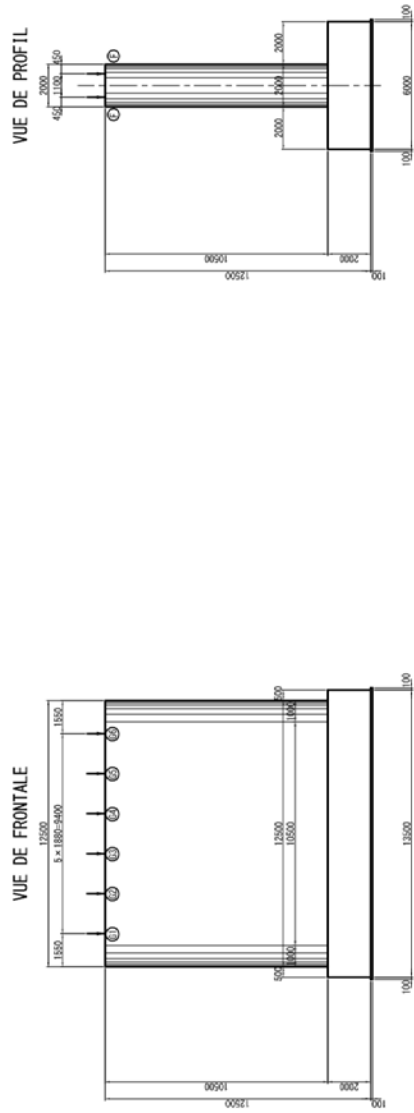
Plan de construction de l'infrastructure du pont sur le fleuve Koumougou (1)
